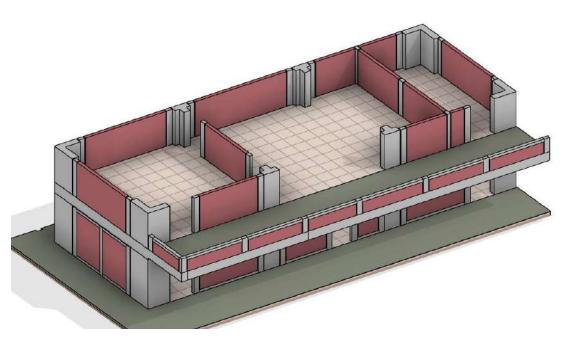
Modelo BIM, Vista en Planta del Primer Nivel del Módulo B.
